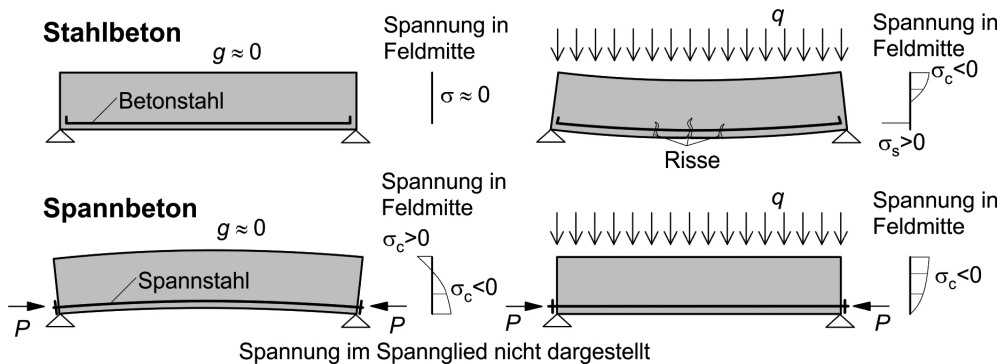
Tragprinzip eines Stahlbeton- und Spannbetonbalkens
